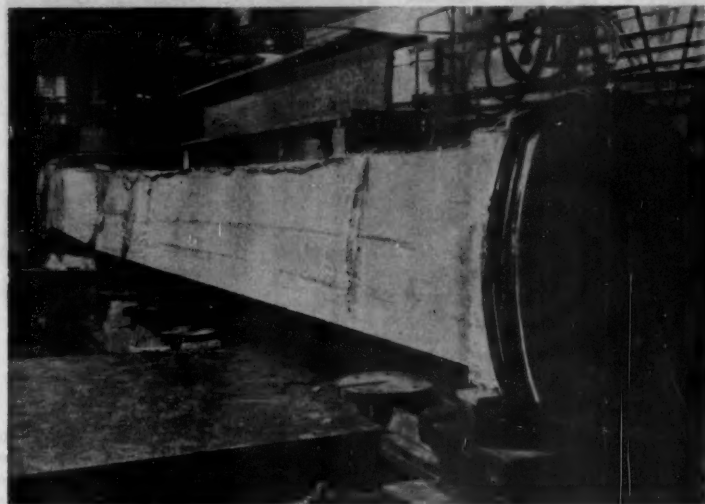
Essai mécanique d'une cloison sur toute sa hauteur.
